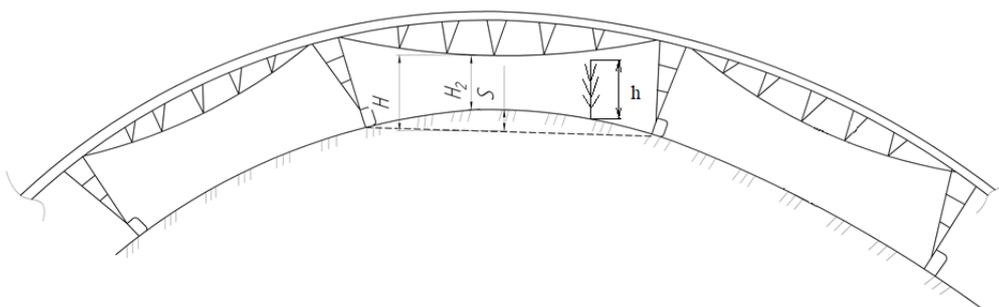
Конструктивно-высотные свойства машин ферменной конструкции водопроводящего пояса
